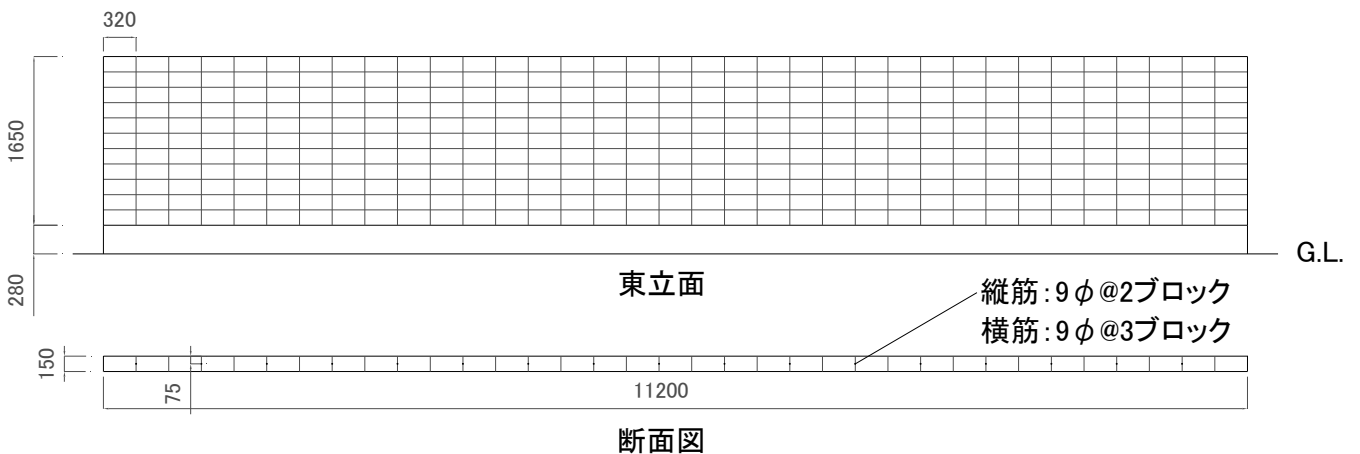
レンガブロック塀の立面図および断面図 (単位: mm)
